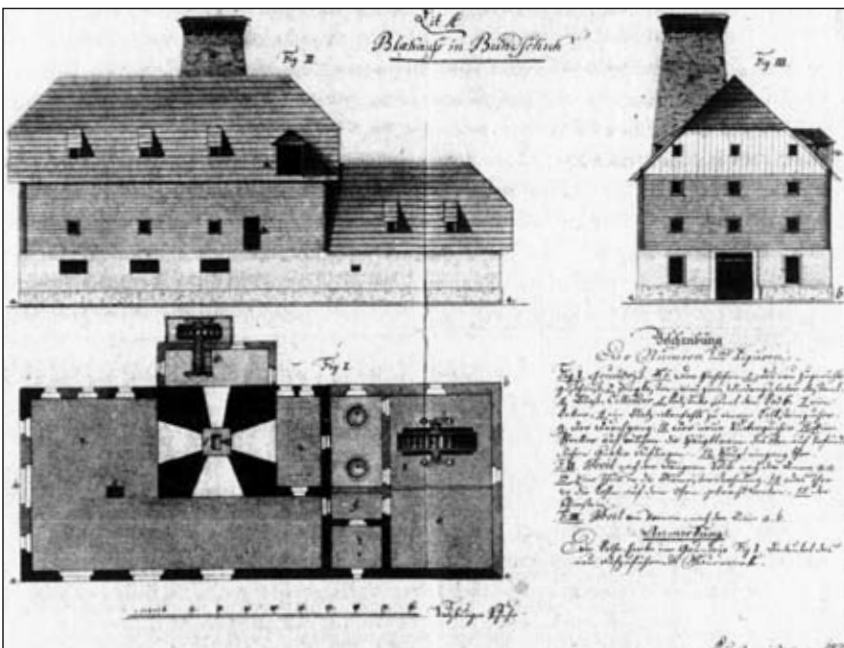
Plan der 1807 in Bundschuh erbauten Hochofenanlage („Blahauss“, Flossofen). Aus Gruber/Ludwig, Salzburger Bergbaugeschichte ... wie Anm. (2)
